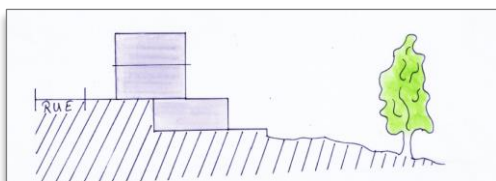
Schnittansicht von einer möglichen Bebauung mit Hangintegration. Quelle: CO3 2017
